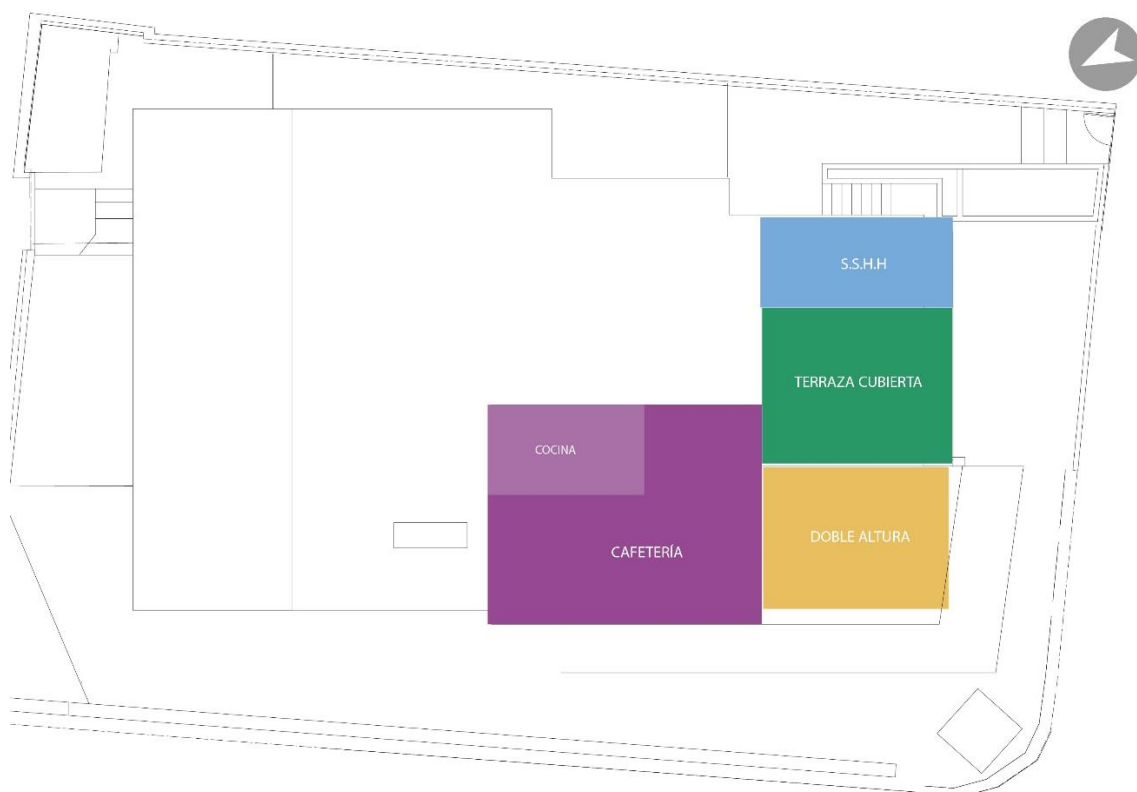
PLAN MASA SEGUNDA PLANTA
